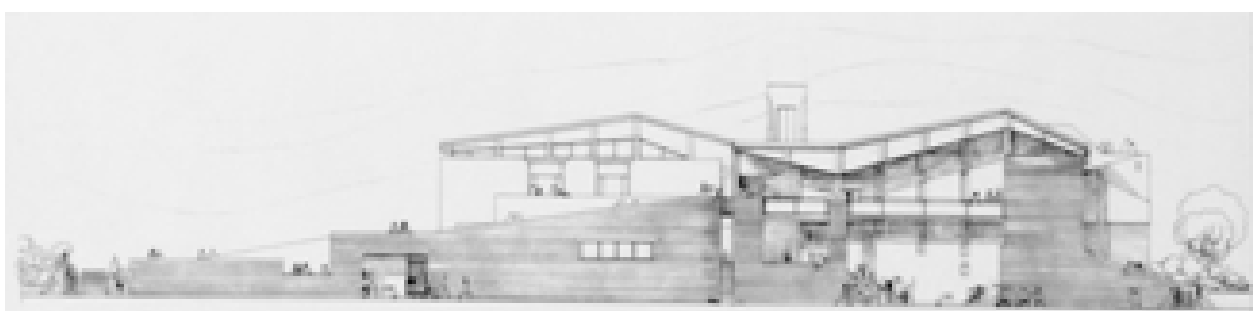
Prospetto Nord, stato futuro –10/09/2007 (AABS-1996.39)
